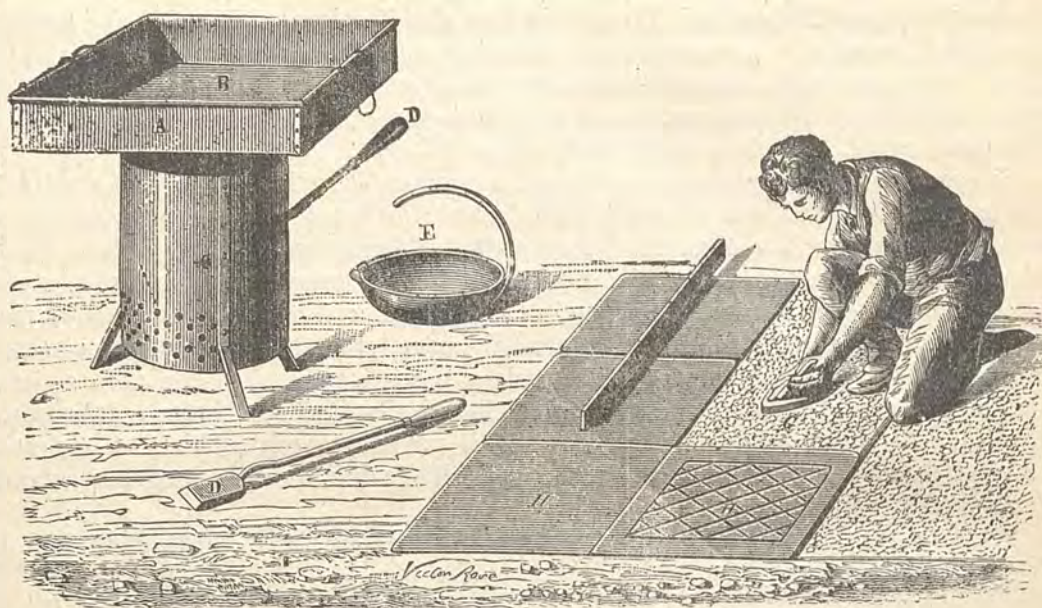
Pavimentazione con lastre di asfalto compresso.
